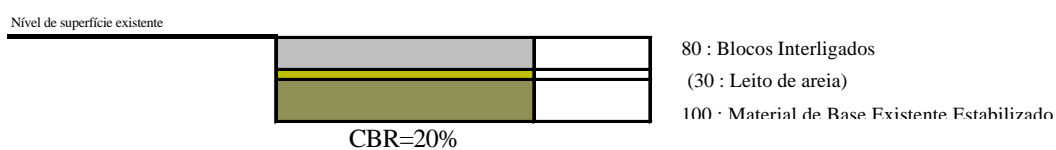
Estruturas de Pavimento Propostas (2)
